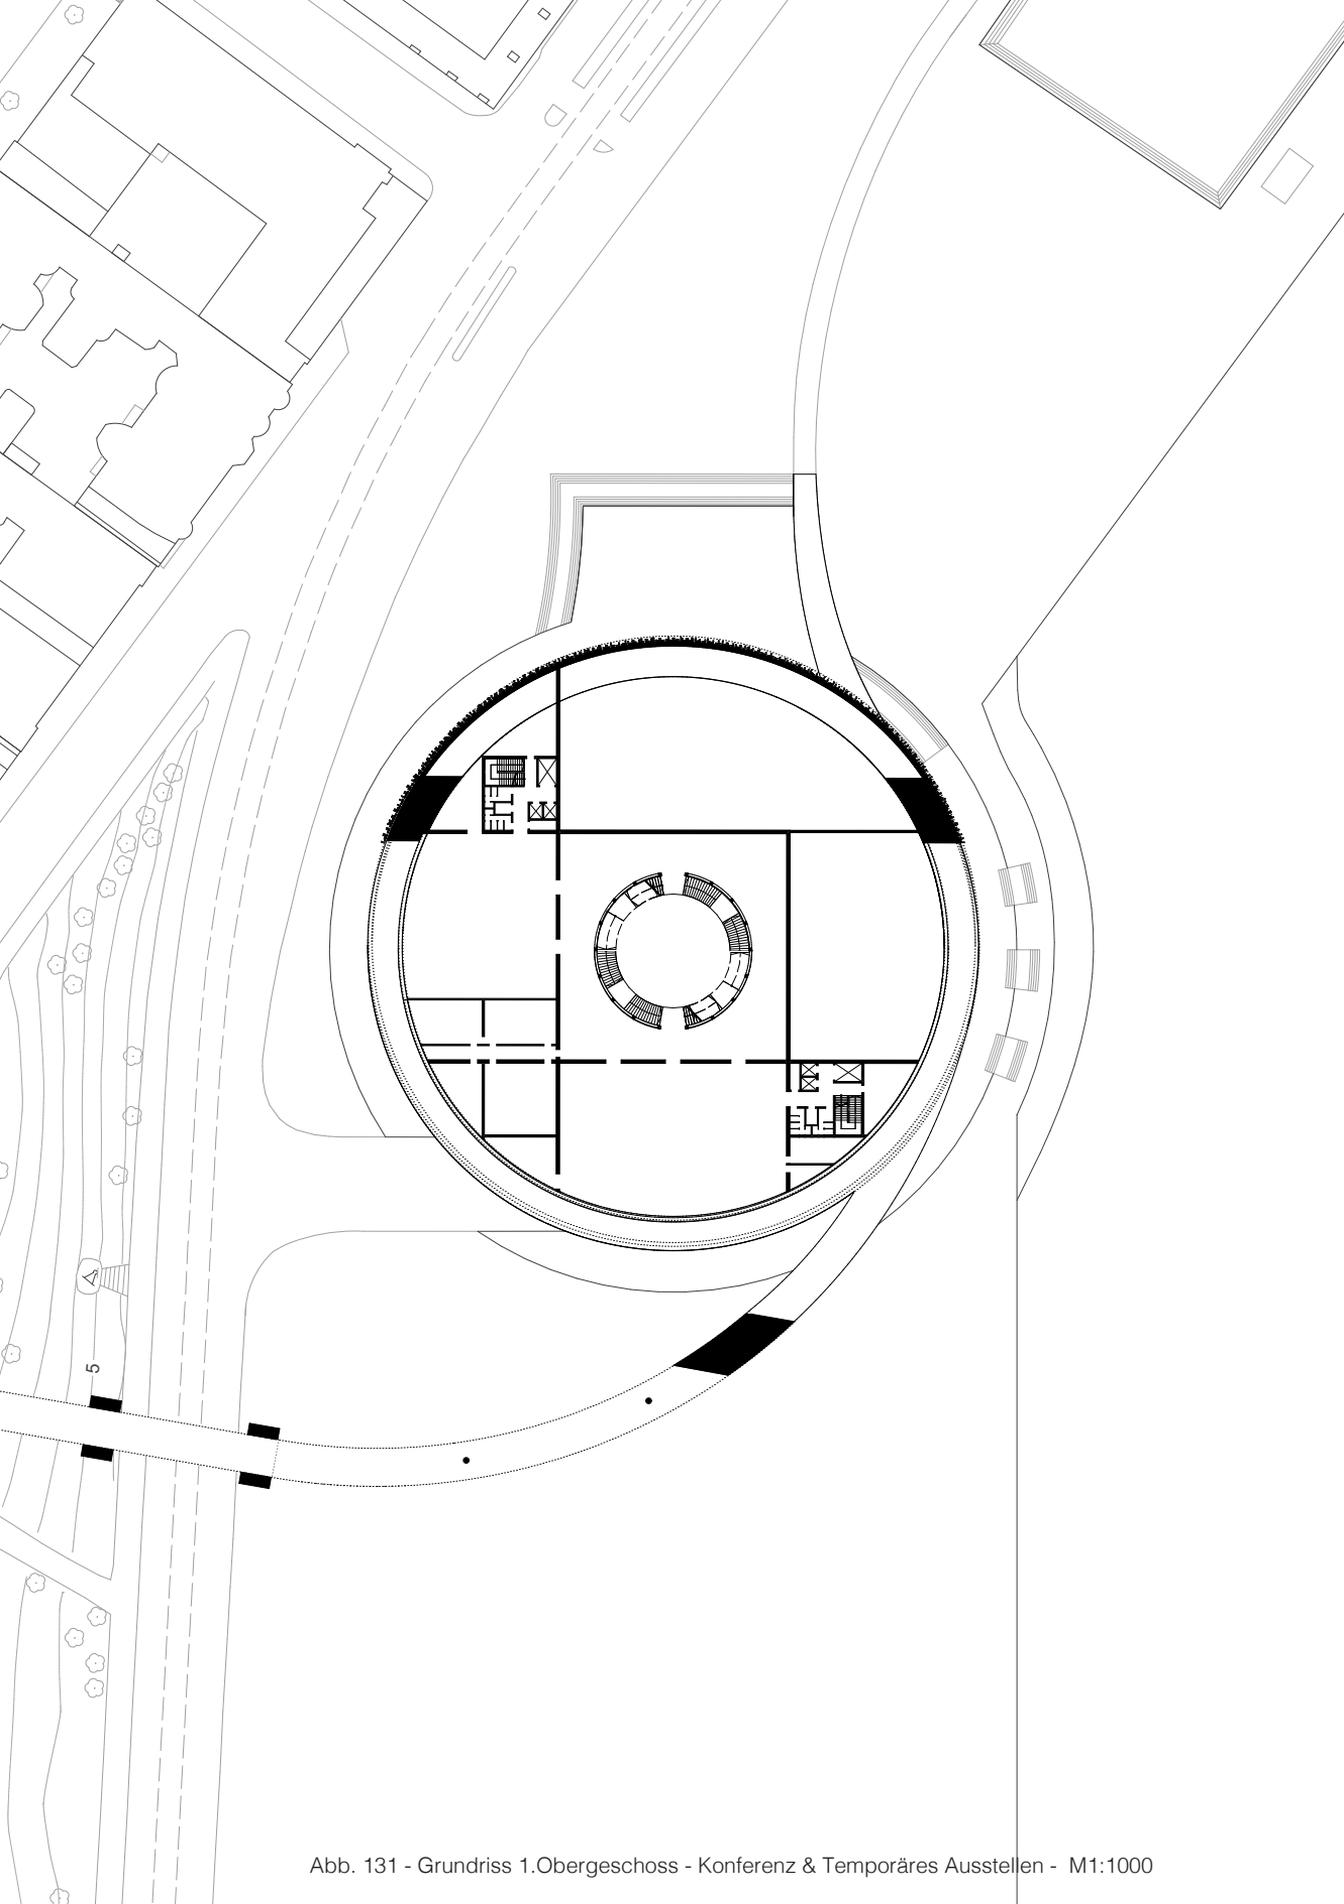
Grundriss 1.Obergeschoss - Konferenz & Temporäres Ausstellen - M1:1000
